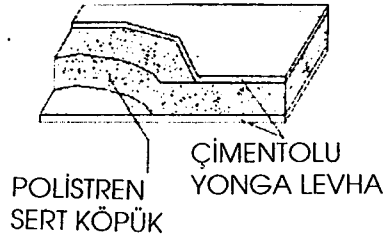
Prefabrike Yapı – Birleşim Detayı
